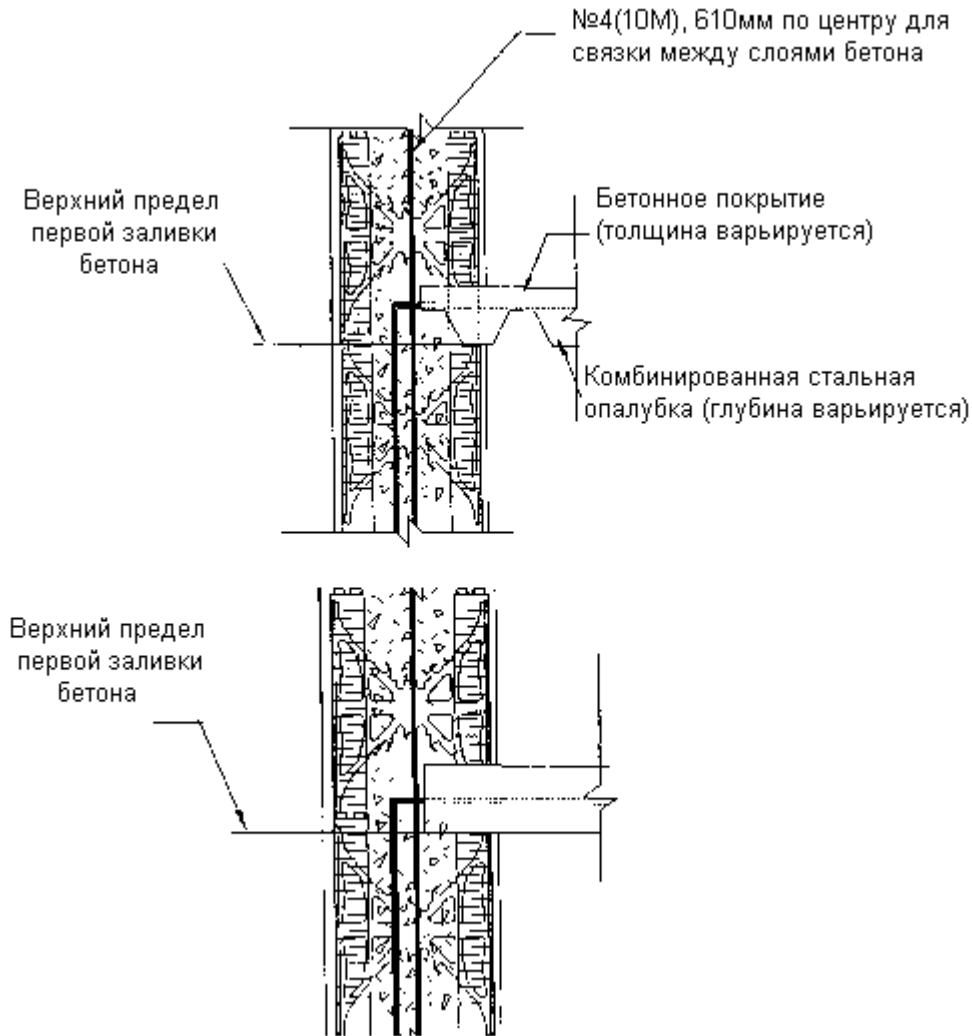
, Комбинированная стальная опалубка с бетонным покрытием
